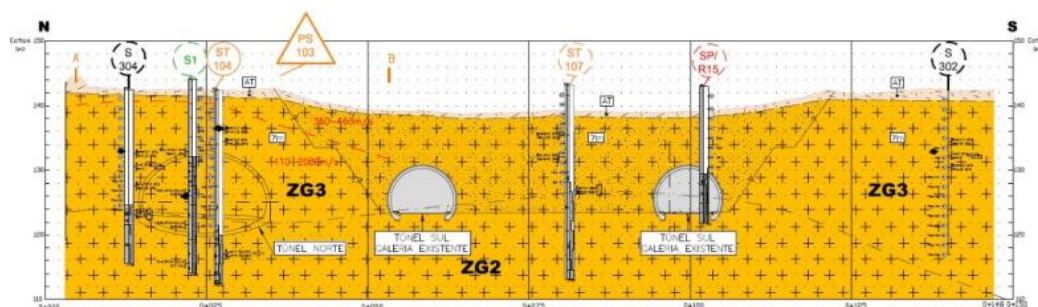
Perfil geológico transversal – Emboquilhamento Nascente
